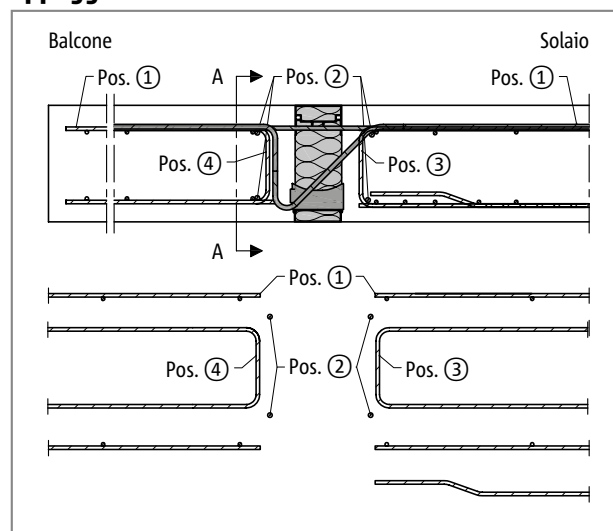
Schöck Isokorb® tipo K, armatura in opera con appoggio indiretto
